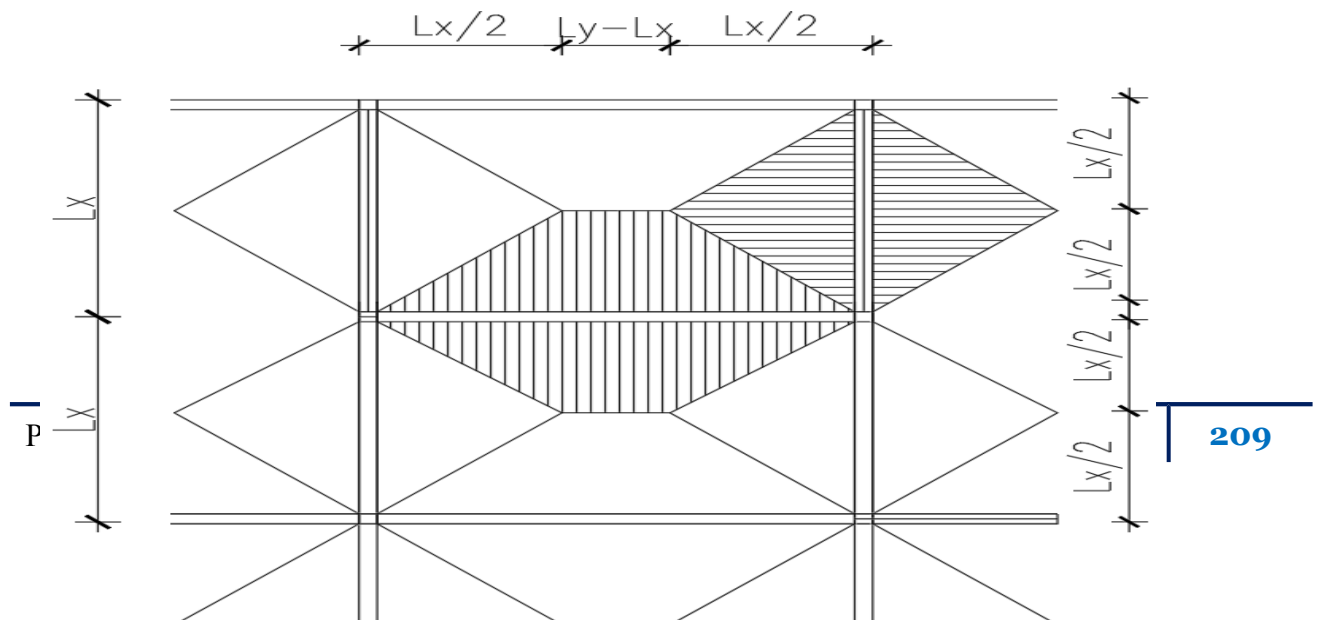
la répartition des charges sur une dalle portée par 4 poutres.
